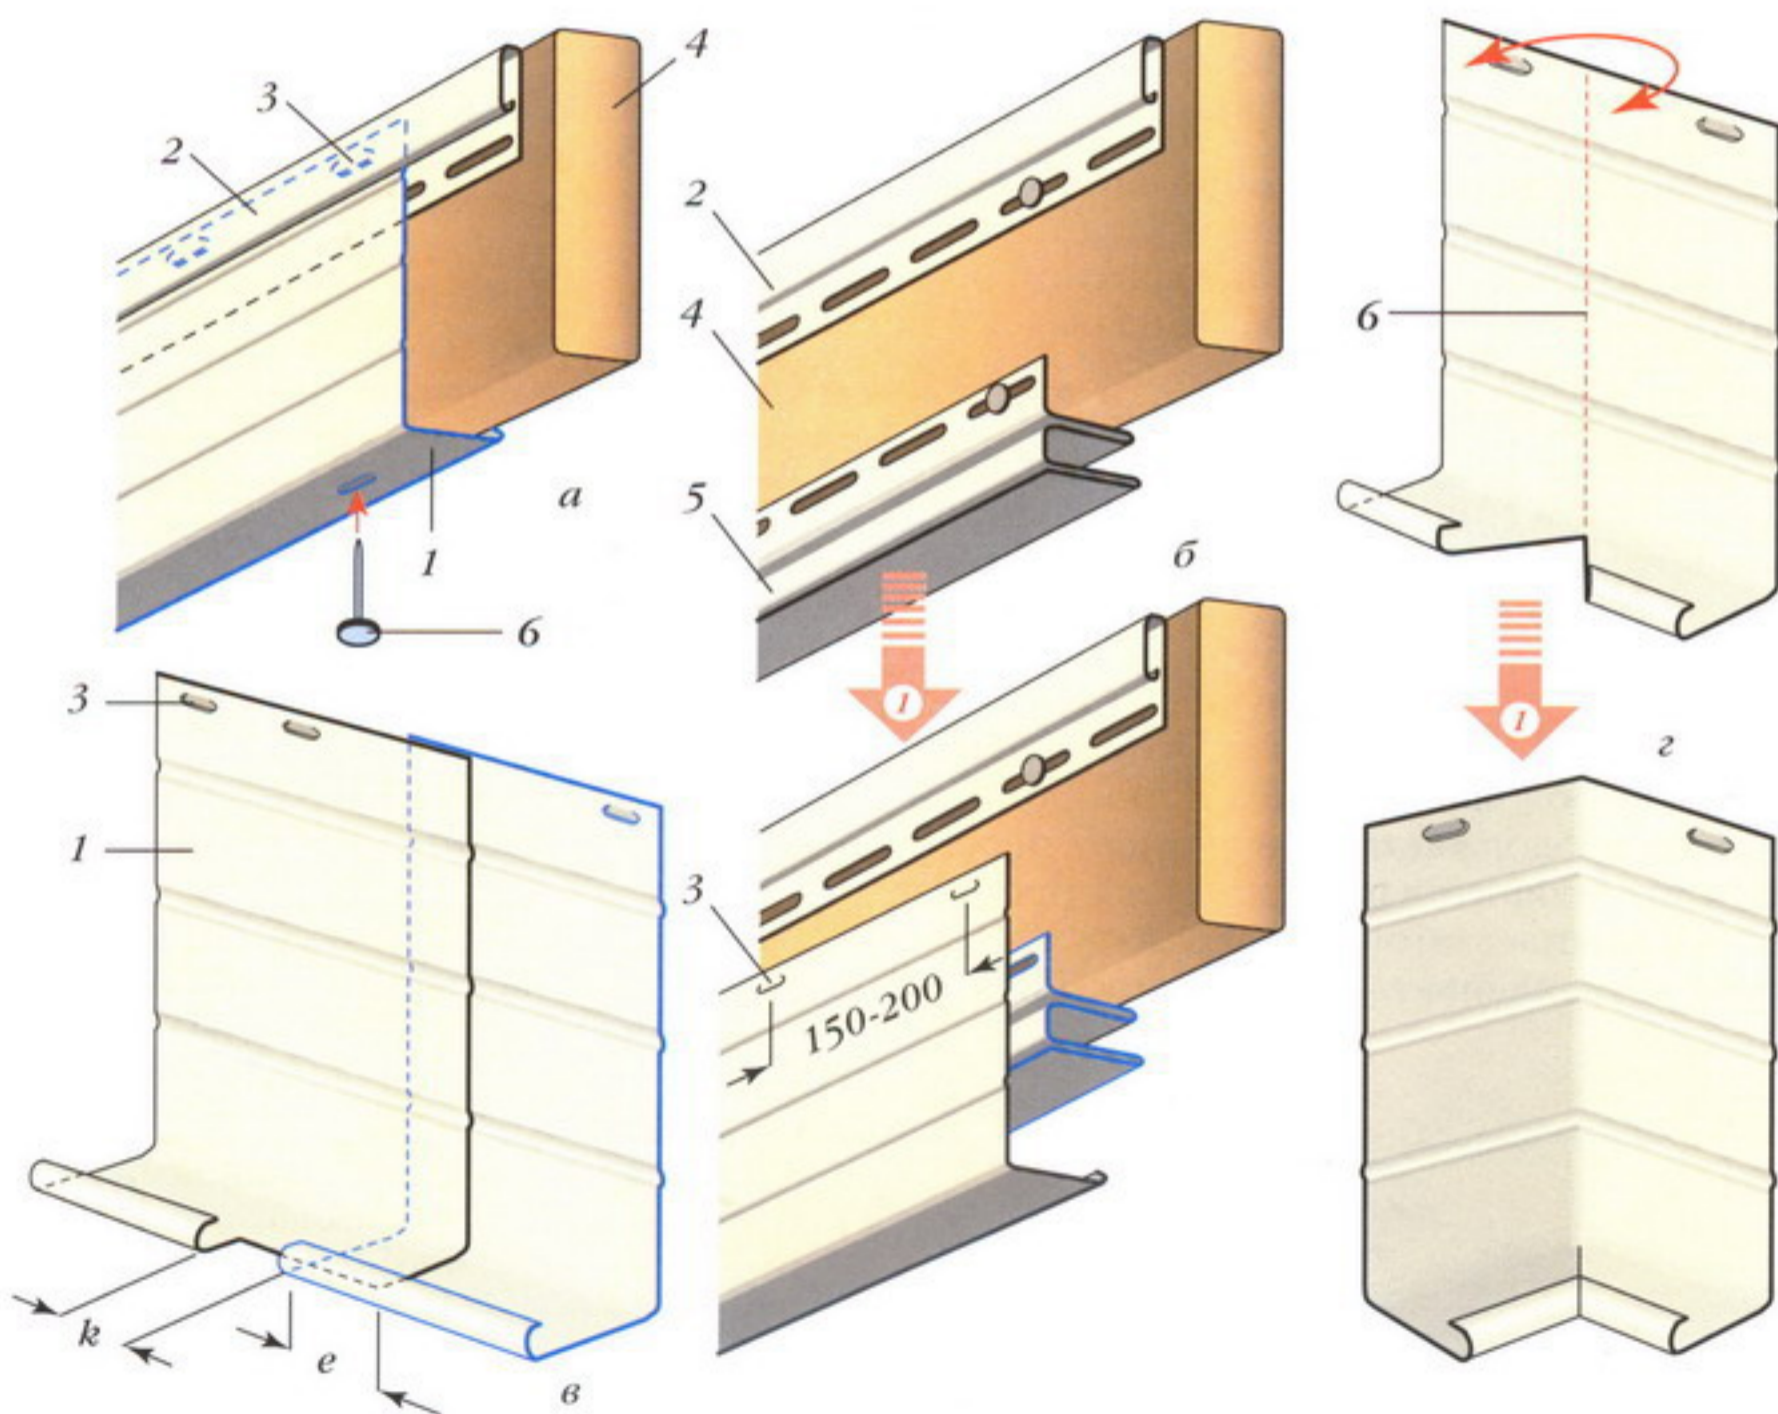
Установка фаски (размеры в мм): а – без софитов; б – с софитами; в – наращивание длины фаски; г – сгибание фаски; 1 – фаска; 2 – завершающий профиль; 3 – зацепы; 4 – деревянная ветровая доска (причелина); 5 – F-профиль или J-профиль; 6 – линия сгиба; k – вертикальный или горизонтальный температурный зазор; e – нахлест
